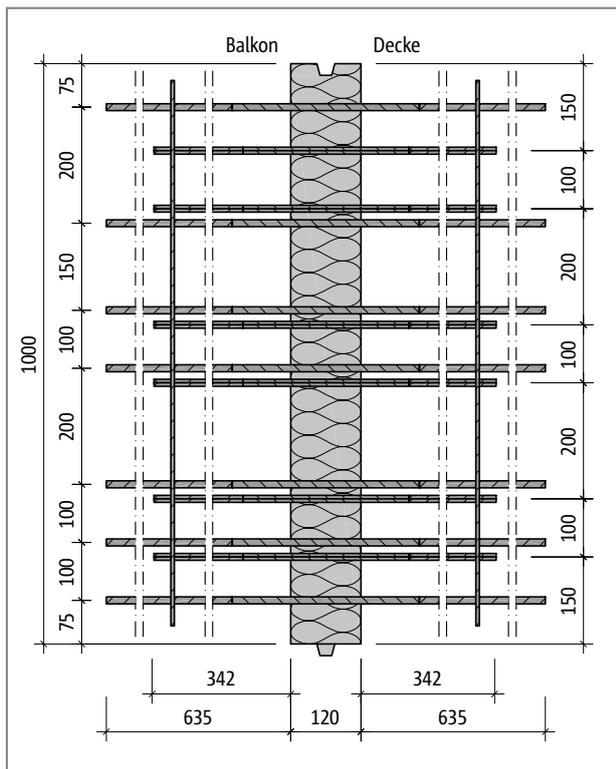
Schöck Isokorb® Typ DXT50-VV6: Grundriss
